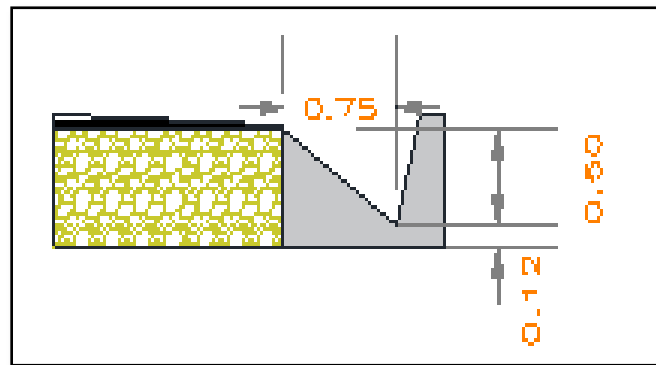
Corte de la sección propuesta para el sistema de alcantarillado pluvial superficial.
